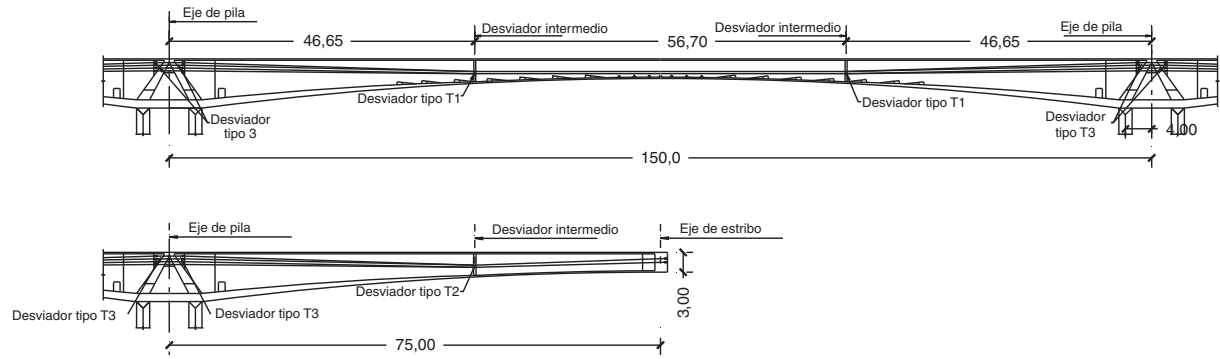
Trazado del pretensado de refuerzo exterior. Alzado longitudinal.
